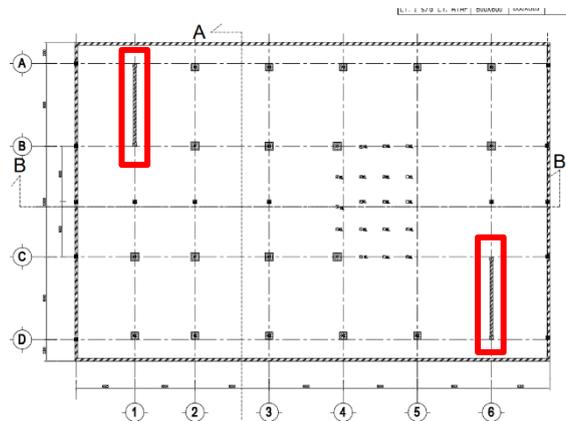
Denah Kolom Swiss-Belinn (Puspita, 2017)
